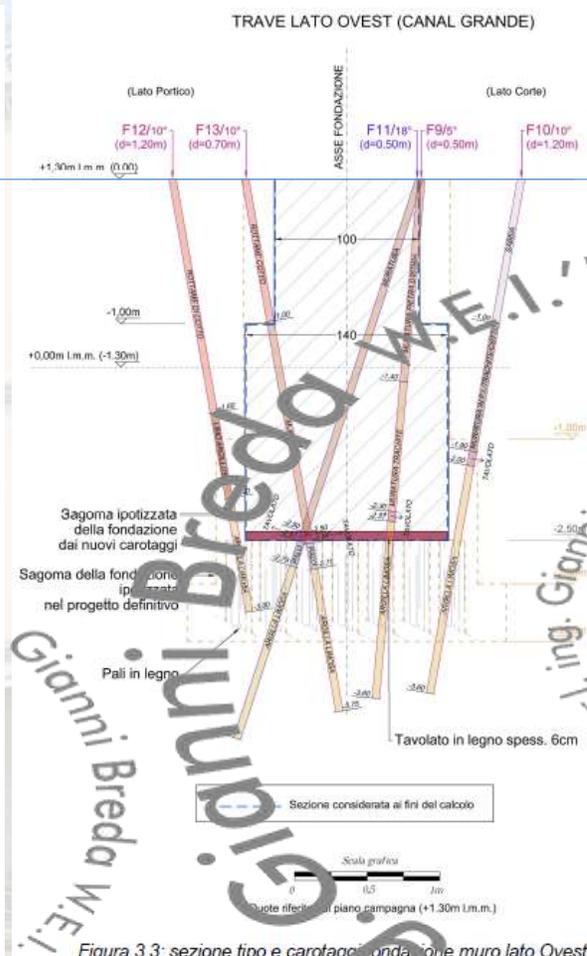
sezione tipo e carotaggi fondazione muro lato Ovest
